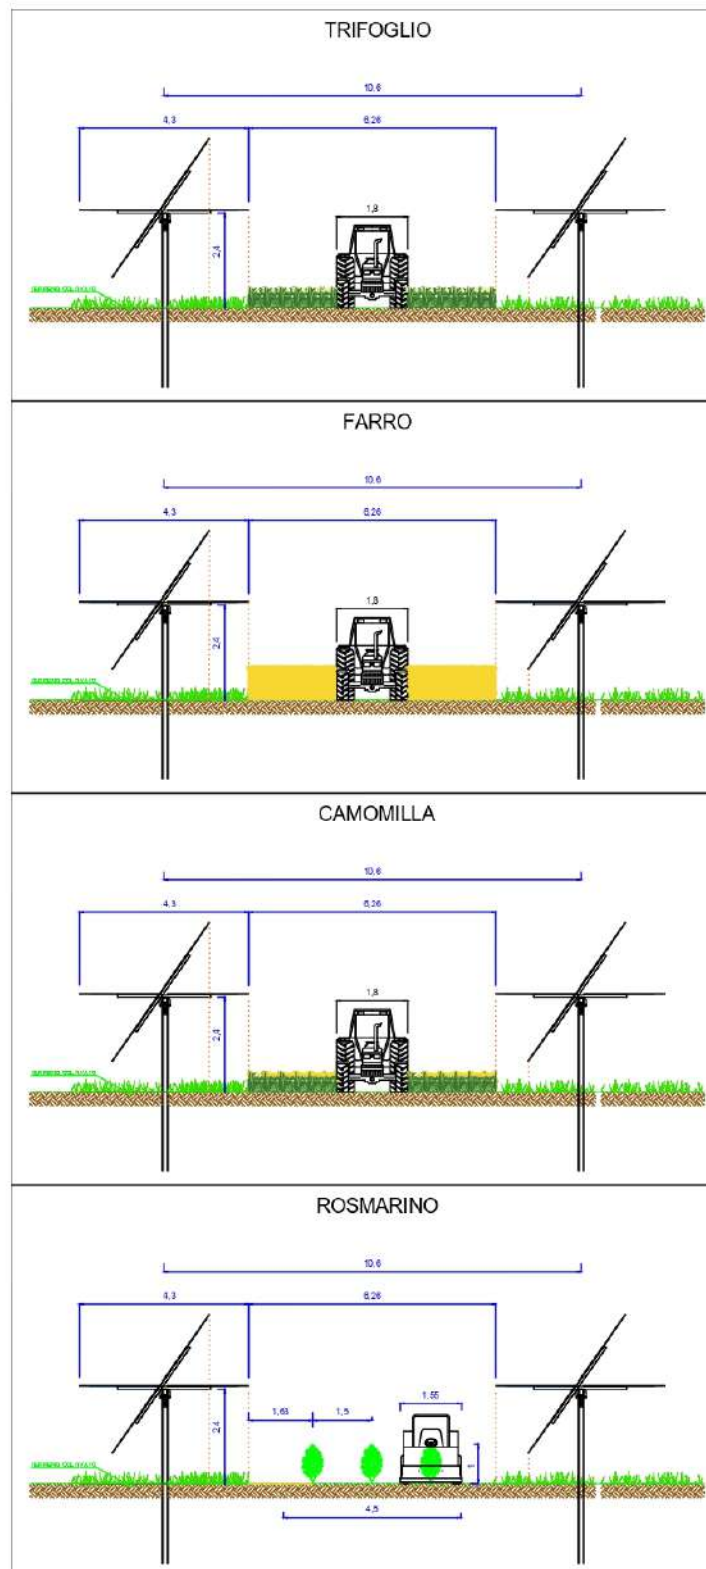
Rappresentazione del prospetto frontale delle colture
